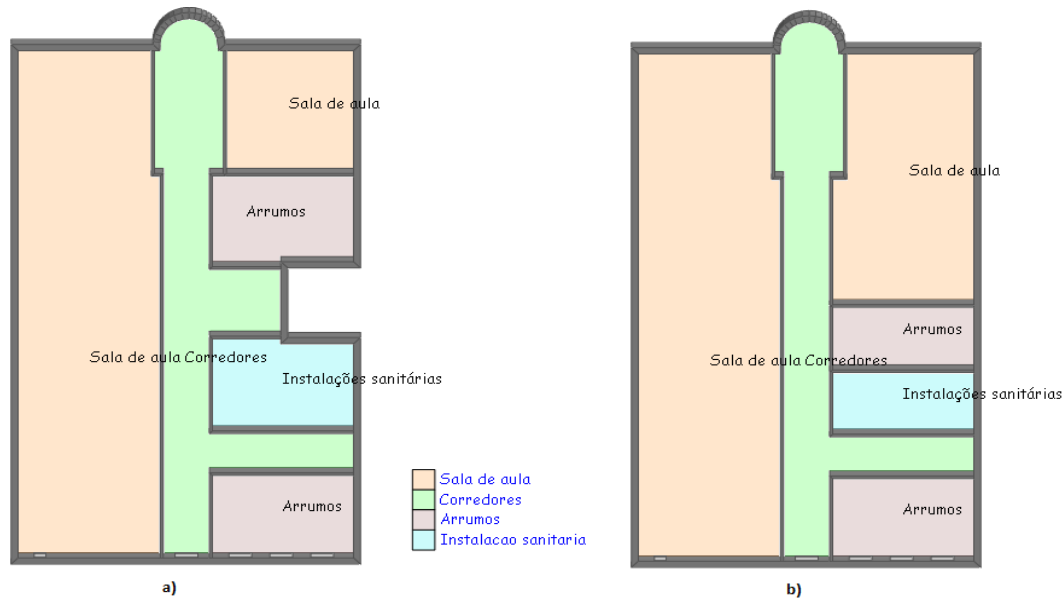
a) Planta do r/c; b) Planta do 1º piso
